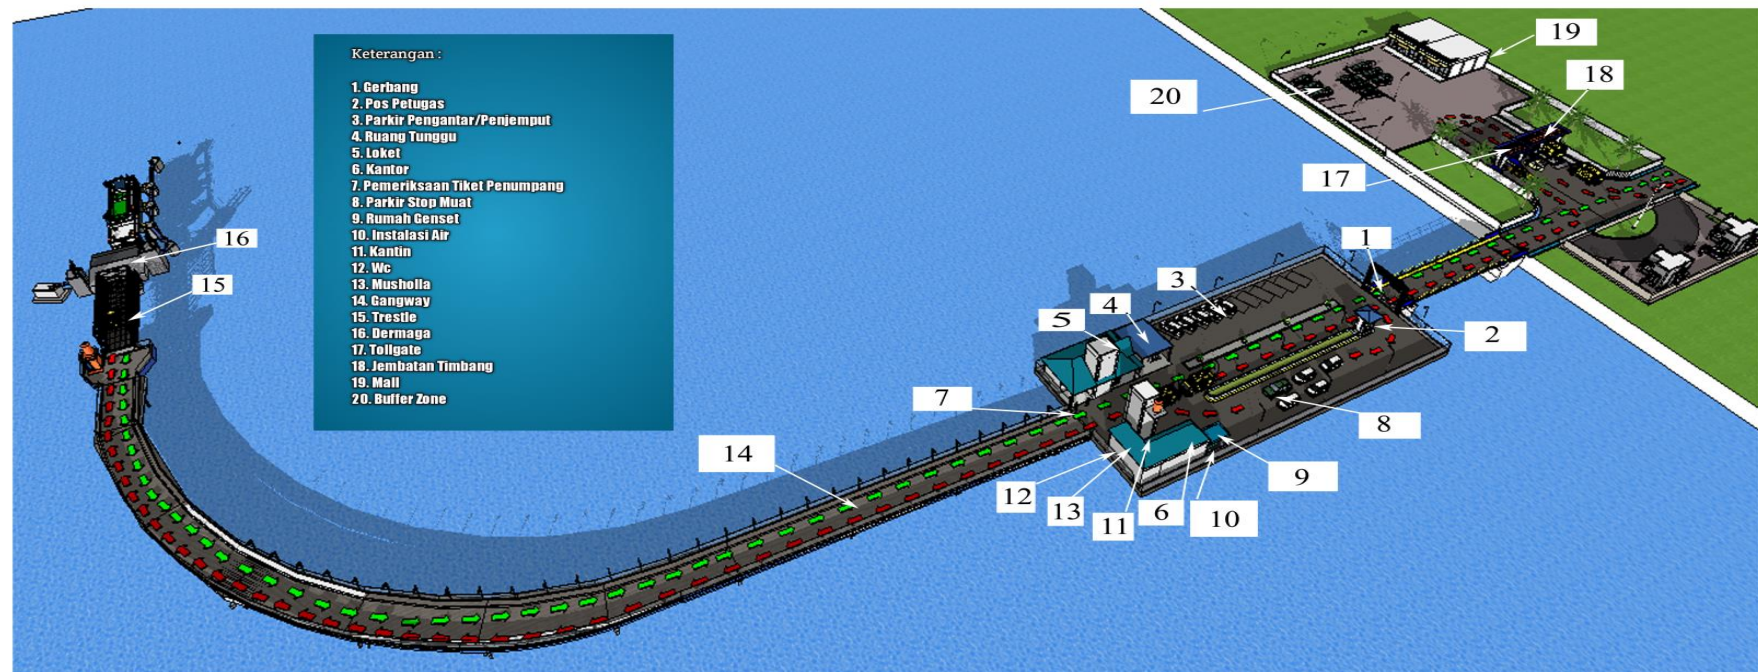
Layout rencana untuk Zona B1 (Jembatan timbang) Zona D (Mall) dan Zona E (Buffer zone) pada daerah rencana pembangunan
